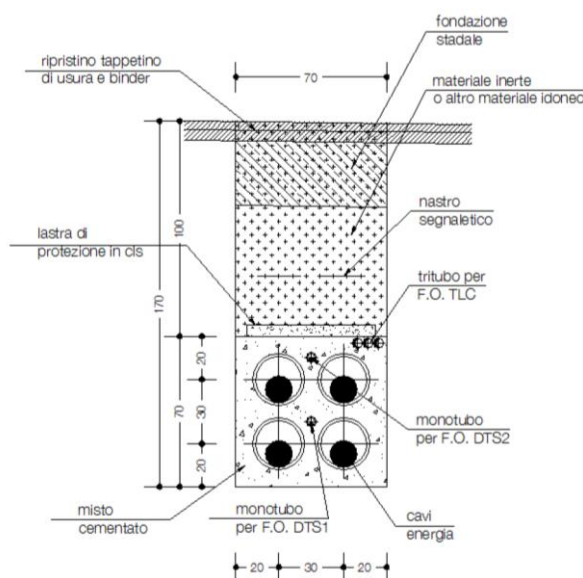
Sezione tipo di posa cavi in trincea (dimensioni in cm).
